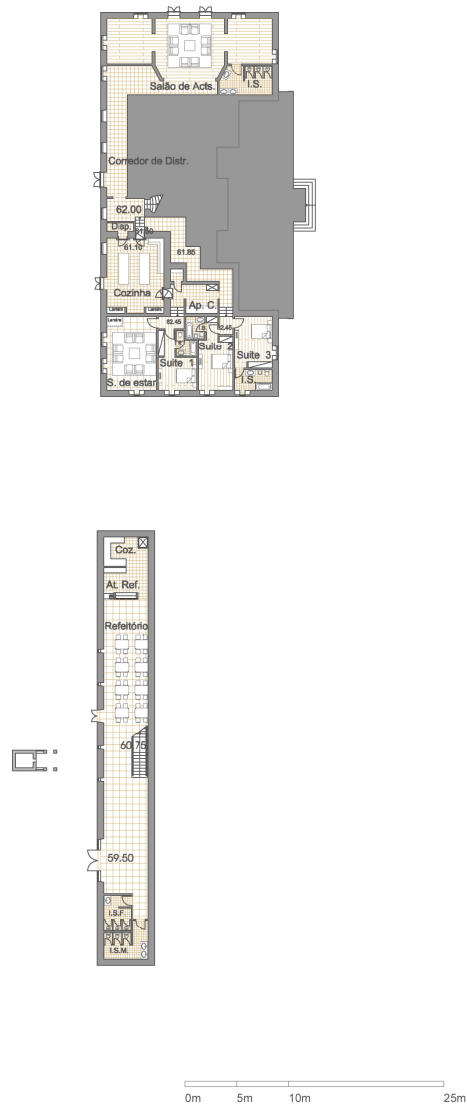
Planta de análise ao conjunto edificado da Quinta da Conceição.
